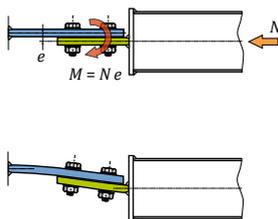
Excentrement d'un assemblage conduisant à une ruine prématurée par flambement du gousset
